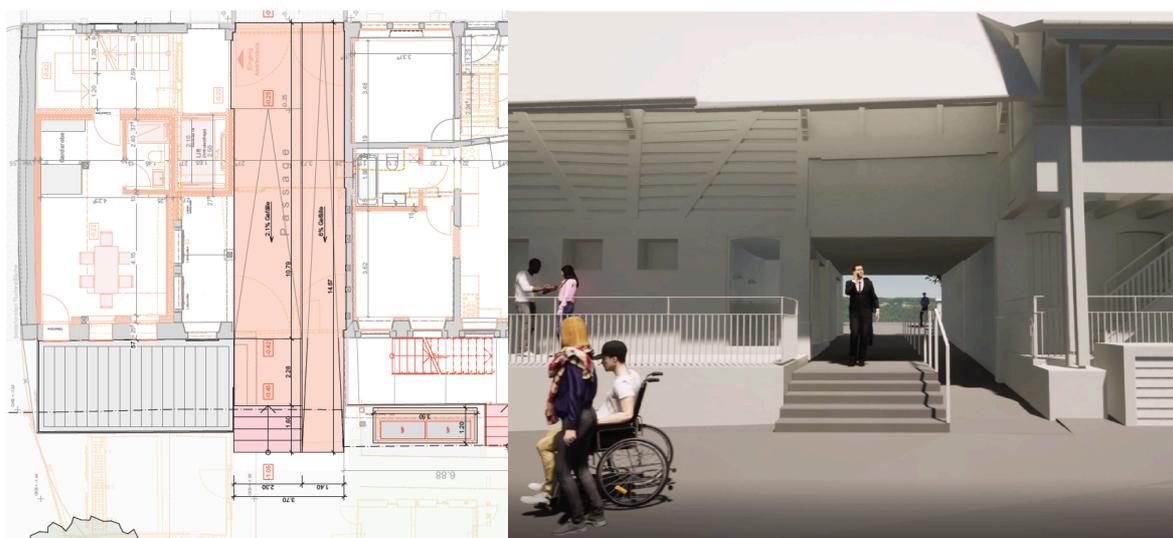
Grundriss und Visualisierung der Passage mit Variante 3.
